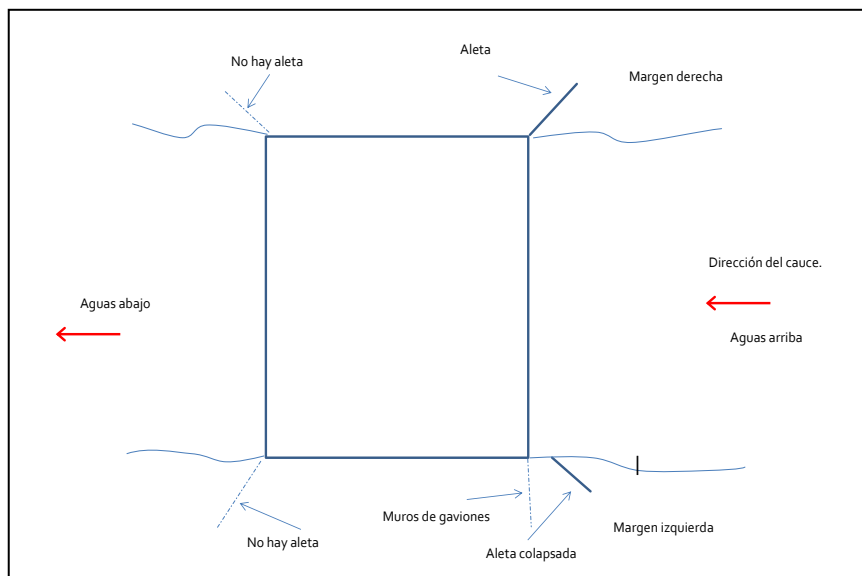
Esquema en Planta Puente Sunuba (TECHINST S.A)
